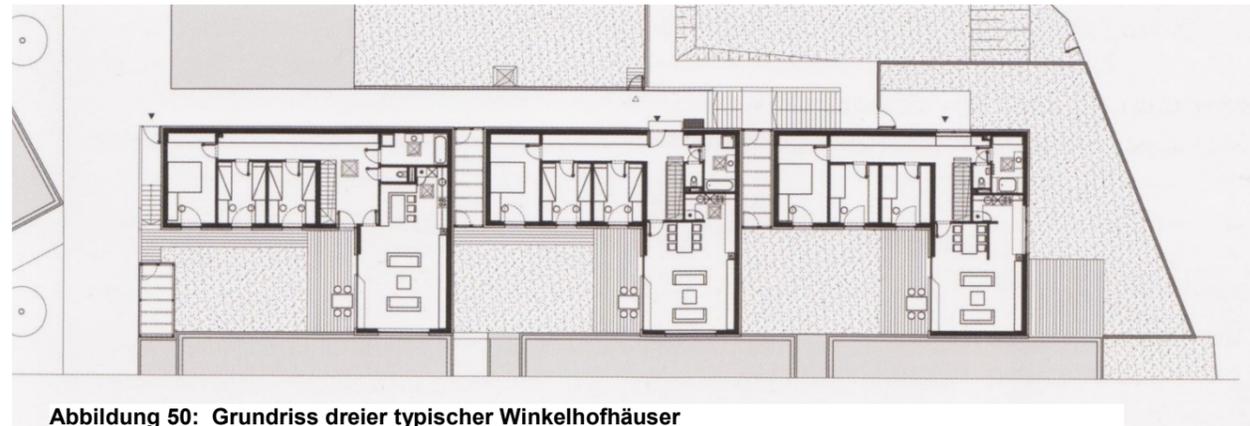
Grundriss dreier typischer Winkelhofhäuser
